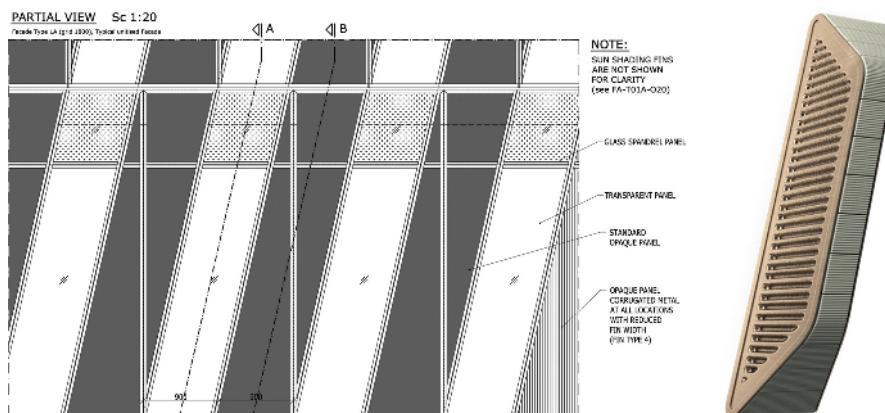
Wasl Tower, Dubai – Fassadenansicht und Rendering der Sonnenschutzelemente (Werner Sobek)
